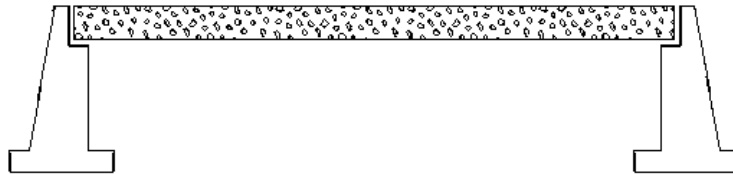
Puente de Vigas Armadas de Vía Inferior. (*ingenierocivilinfo.com*, 2015)
